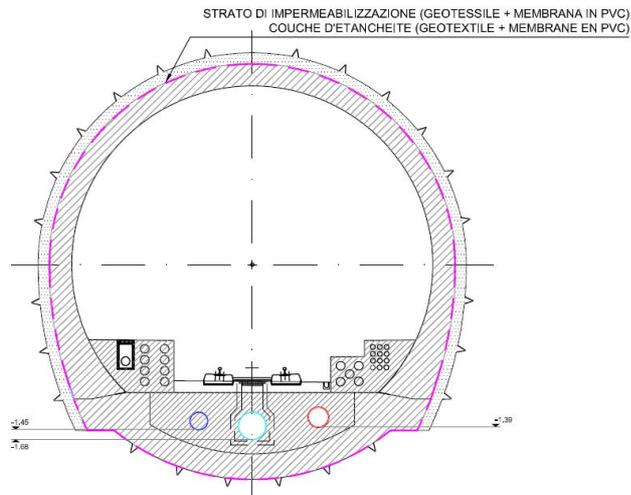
Impermeabilizzazione di tipo 2/2a per scavo tradizionale
